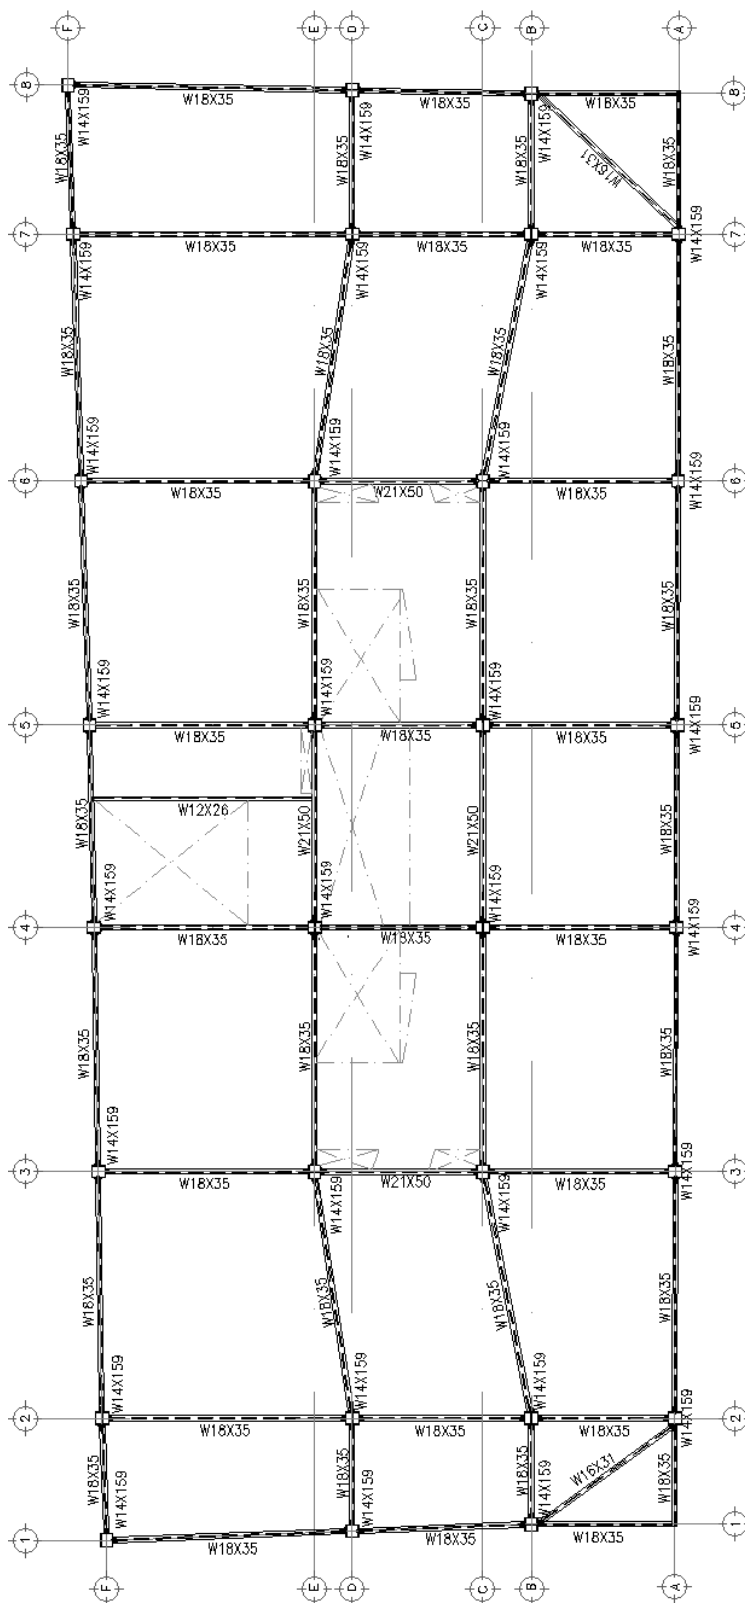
Planta estructural de los pisos 9, 10, 11 y 12.
